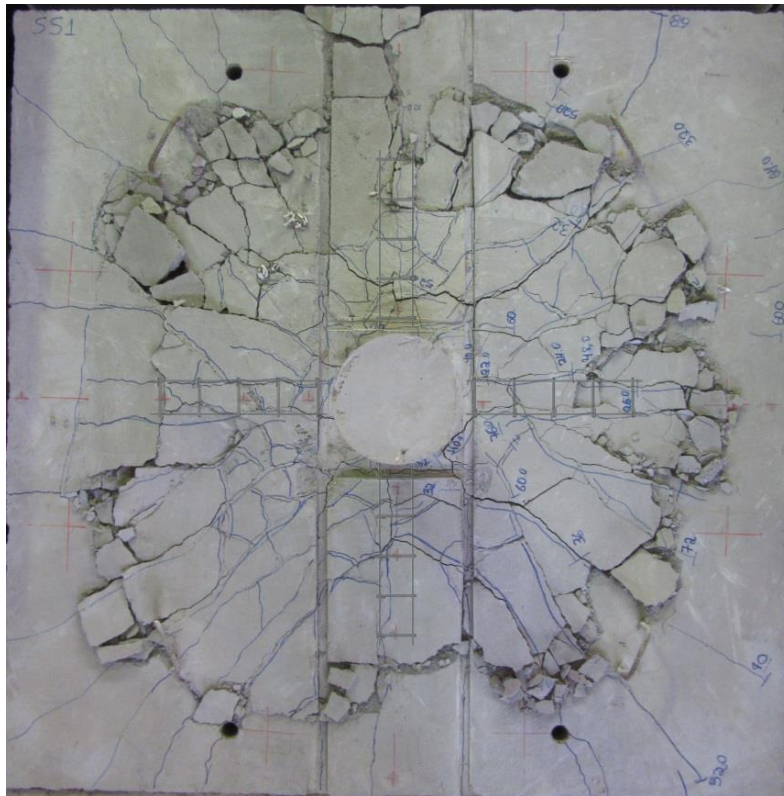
Mapa de fissuração da laje SS1
